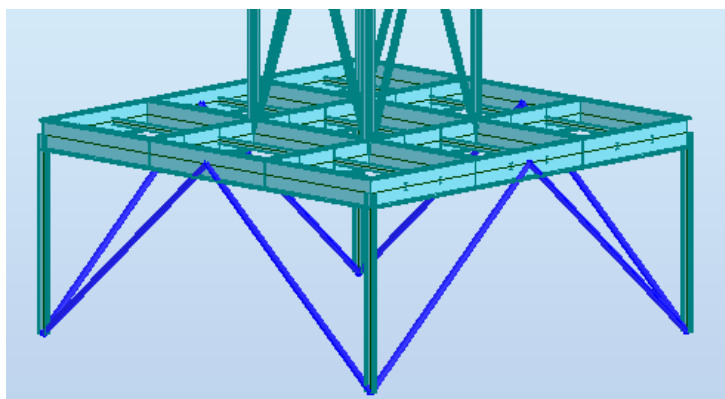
Barras das diagonais da estrutura metálica de suporte
